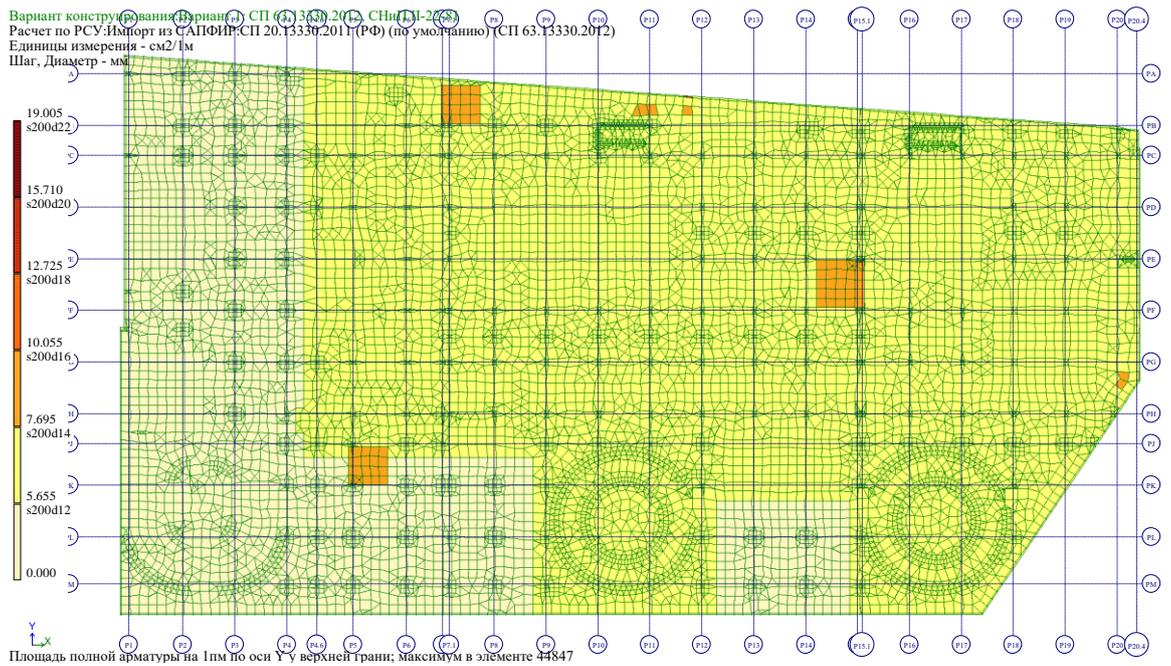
Армирование фундаментной плиты. Площадь полной арматуры на 1м по оси Y у верхней грани
